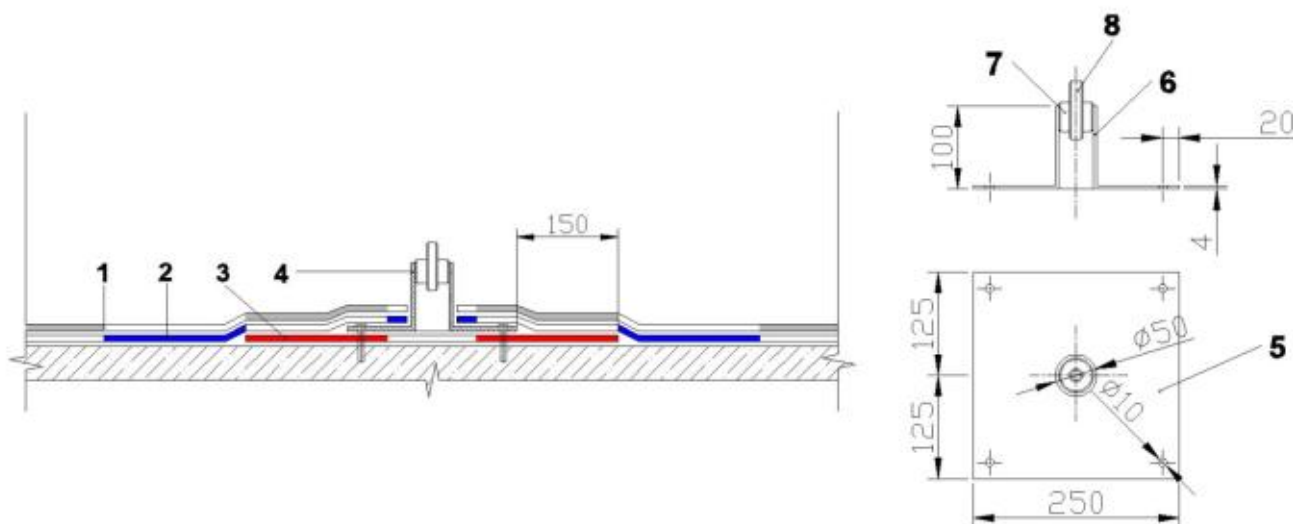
Примыкание кровельного ковра к анкерам, антенным растяжкам и оборудованию.
